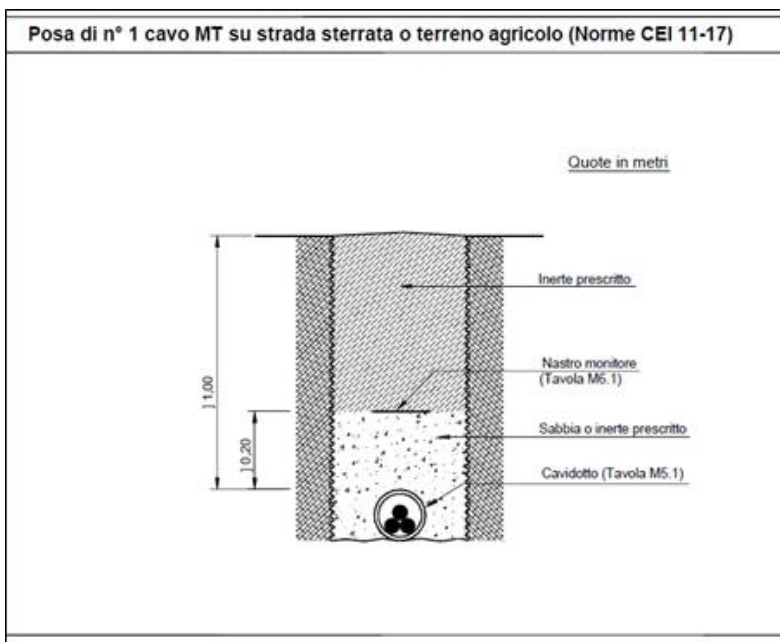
Sezione tipica di posa della linea in cavo in MT su strada sterrata
